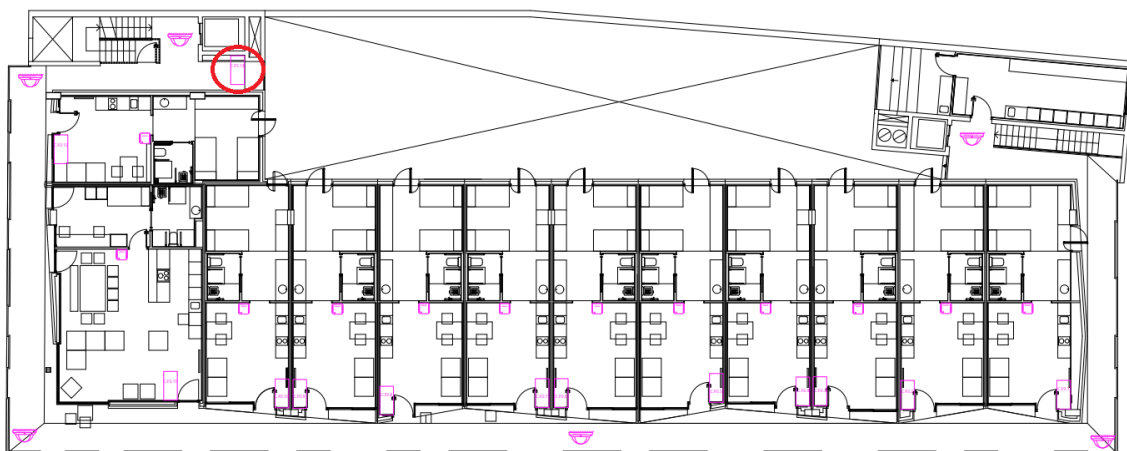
Ubicación cuadro 1 de la segunda planta (C.P2.1).
